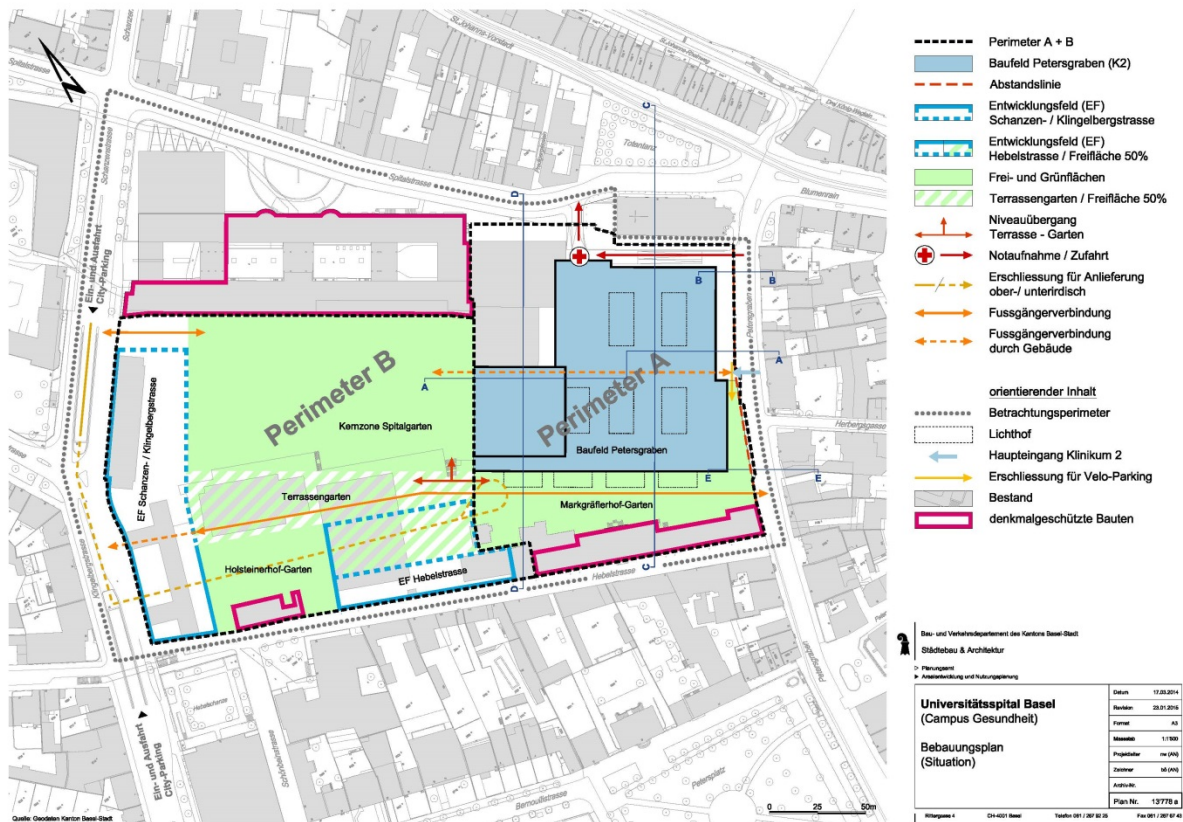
Neuer Bebauungsplan Campus Gesundheit (Plan-Nr. 13'778 a), Quelle: BVD
